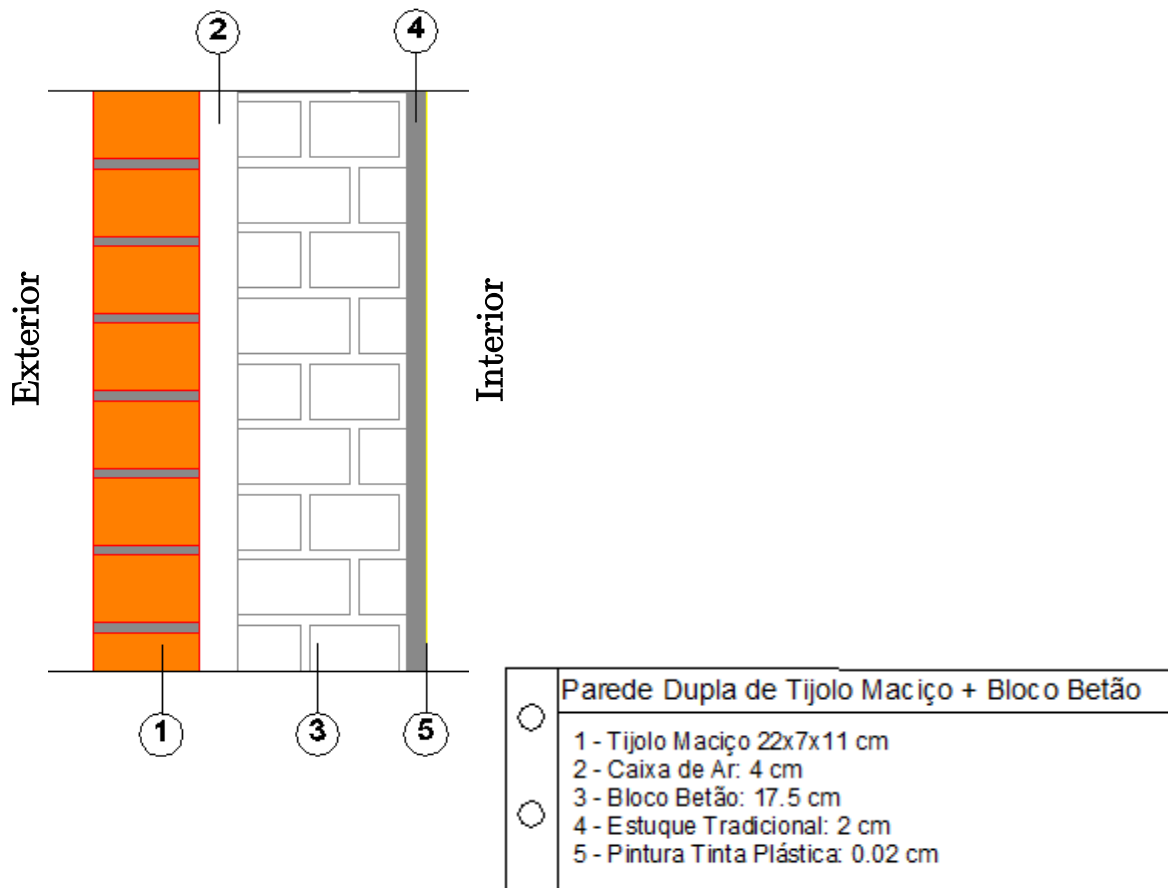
Parede dupla de tijolo maciço pelo exterior e bloco de betão pelo interior
